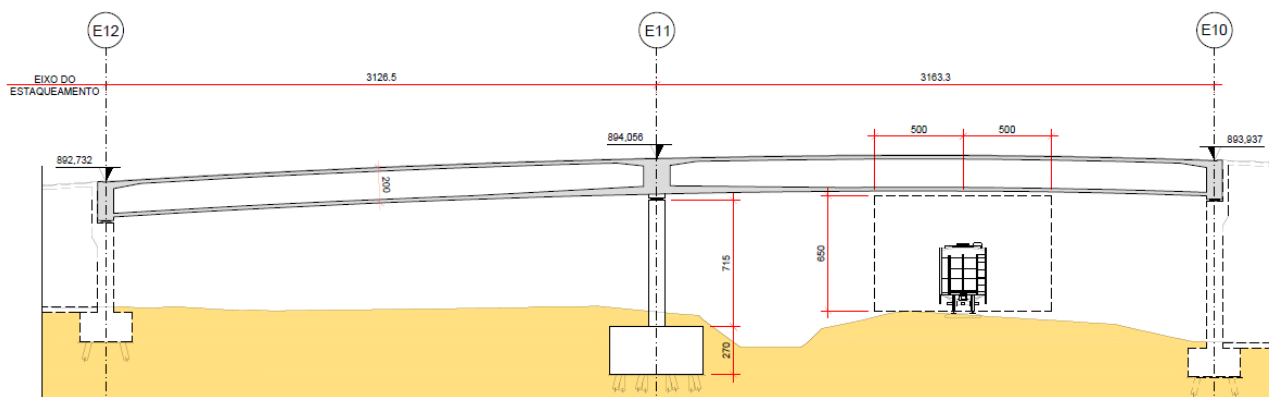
ELEVÇÃO VIADUTO (RAMO 400)
